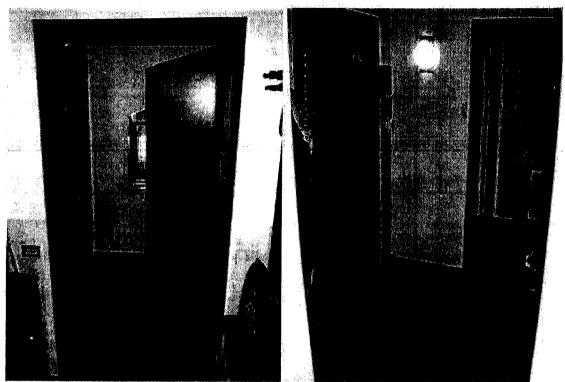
e 134 - Rilievo interno – Porta di accesso all'alloggio del secondo piano (Sub. 3) e locale disimpegno di ingresso.
